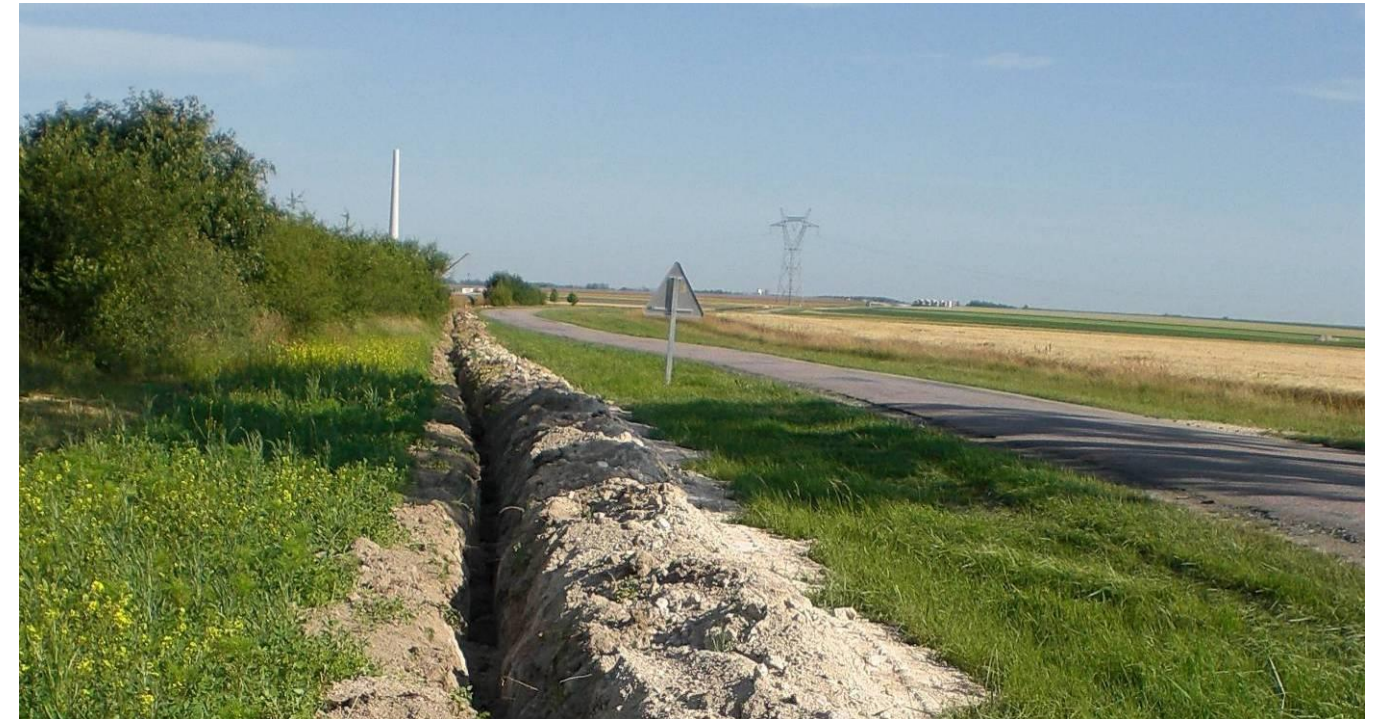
Rebouchage de tranchée après passage des câbles électriques (Source : BE JC)
